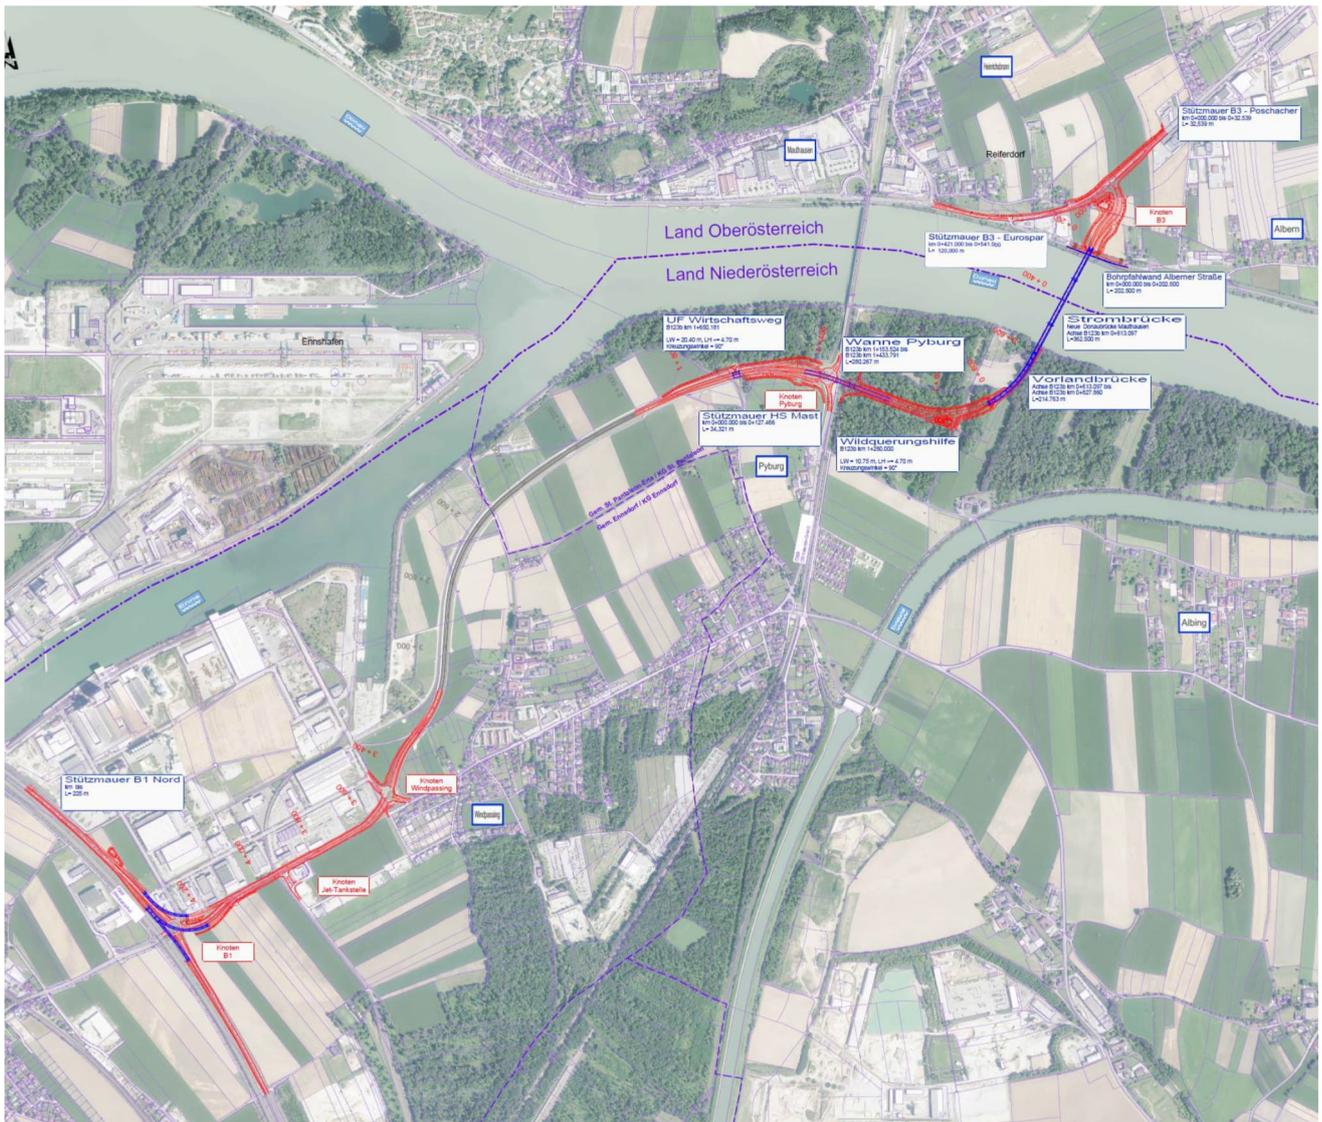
Übersichtslageplan (Quelle: Einlage B.02.01.01)
